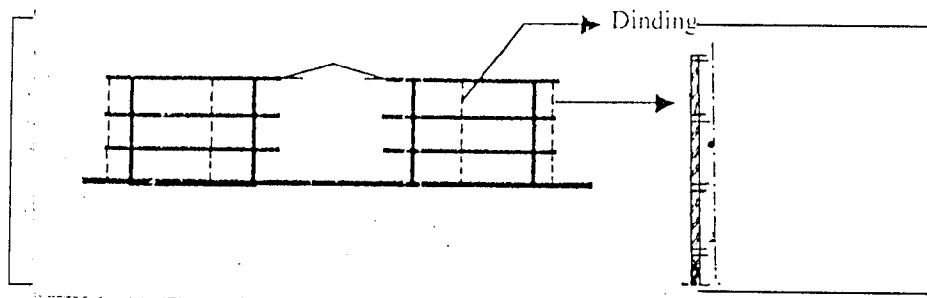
Struktur pondasi, kolom, dan balok
